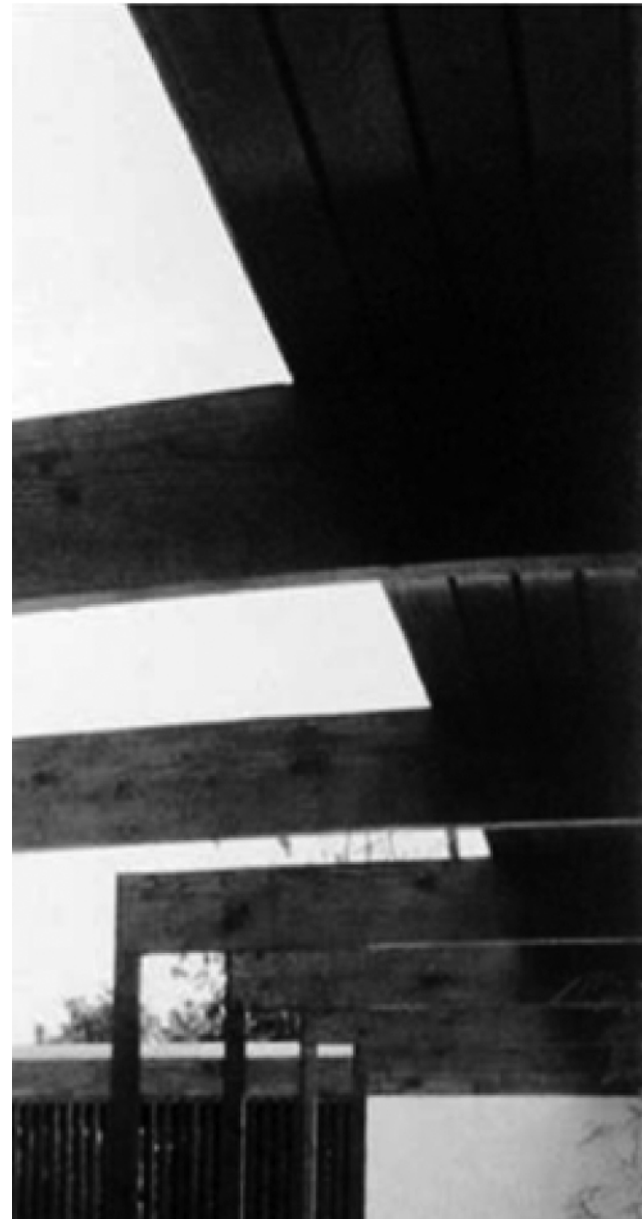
DETALLE DE VIGAS / FOTO SCHULMAN.
